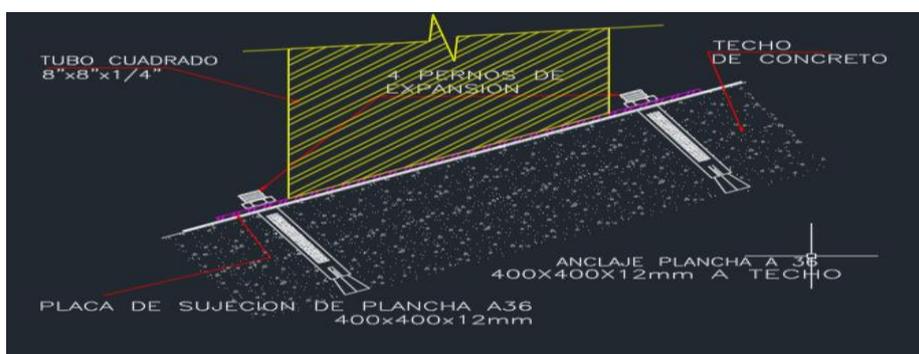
Detalle de soporte empotrado a viga de concreto
